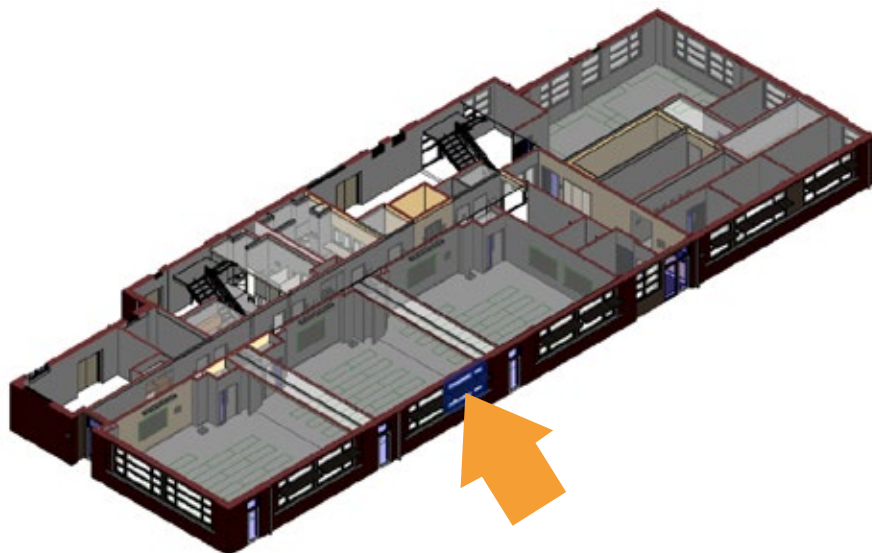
Uso de uma ferramenta de corte dinâmico (num plano paralelo à laje piso do pavimento), aplicado a uma vista 3D de um determinado pavimento de um modelo BIM. Note a janela destacada em azul, que está posicionada erroneamente, numa cota mais alta que as demais (Fonte: *The US Army Corps of Engineers: Revit QA/QC from the Owner's Perspective - Van Woods & Tim Grimm - USACE*)
